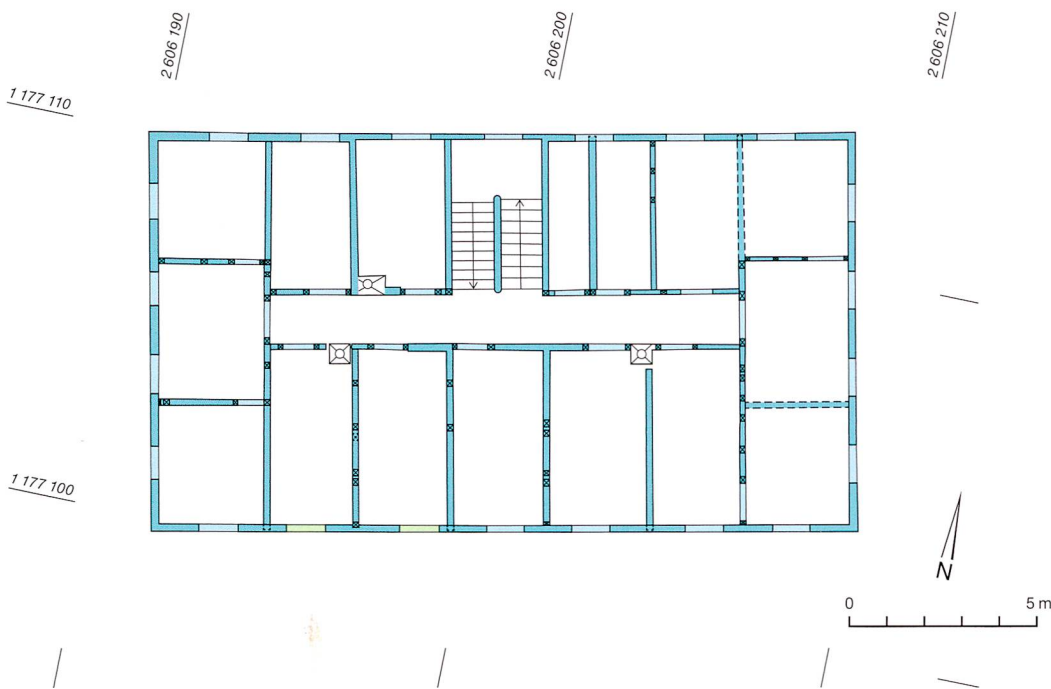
Blumenstein, Badstrasse 37. Grundriss mit Raumeinteilung im ersten Obergeschoss. Die beiden Suiten befanden sich am jeweiligen Stockwerkende und wurden über den Mittelgang erschlossen. Die einfacheren Zimmer lagen quer dazu. M. 1:200.
